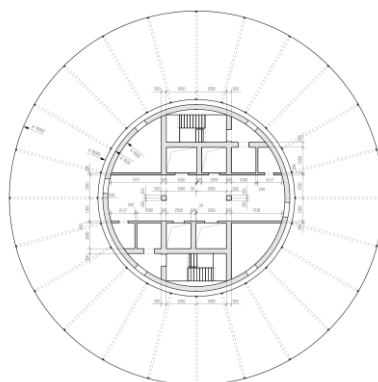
План типового этажа здания со ствольно-подвесной несущей системой
